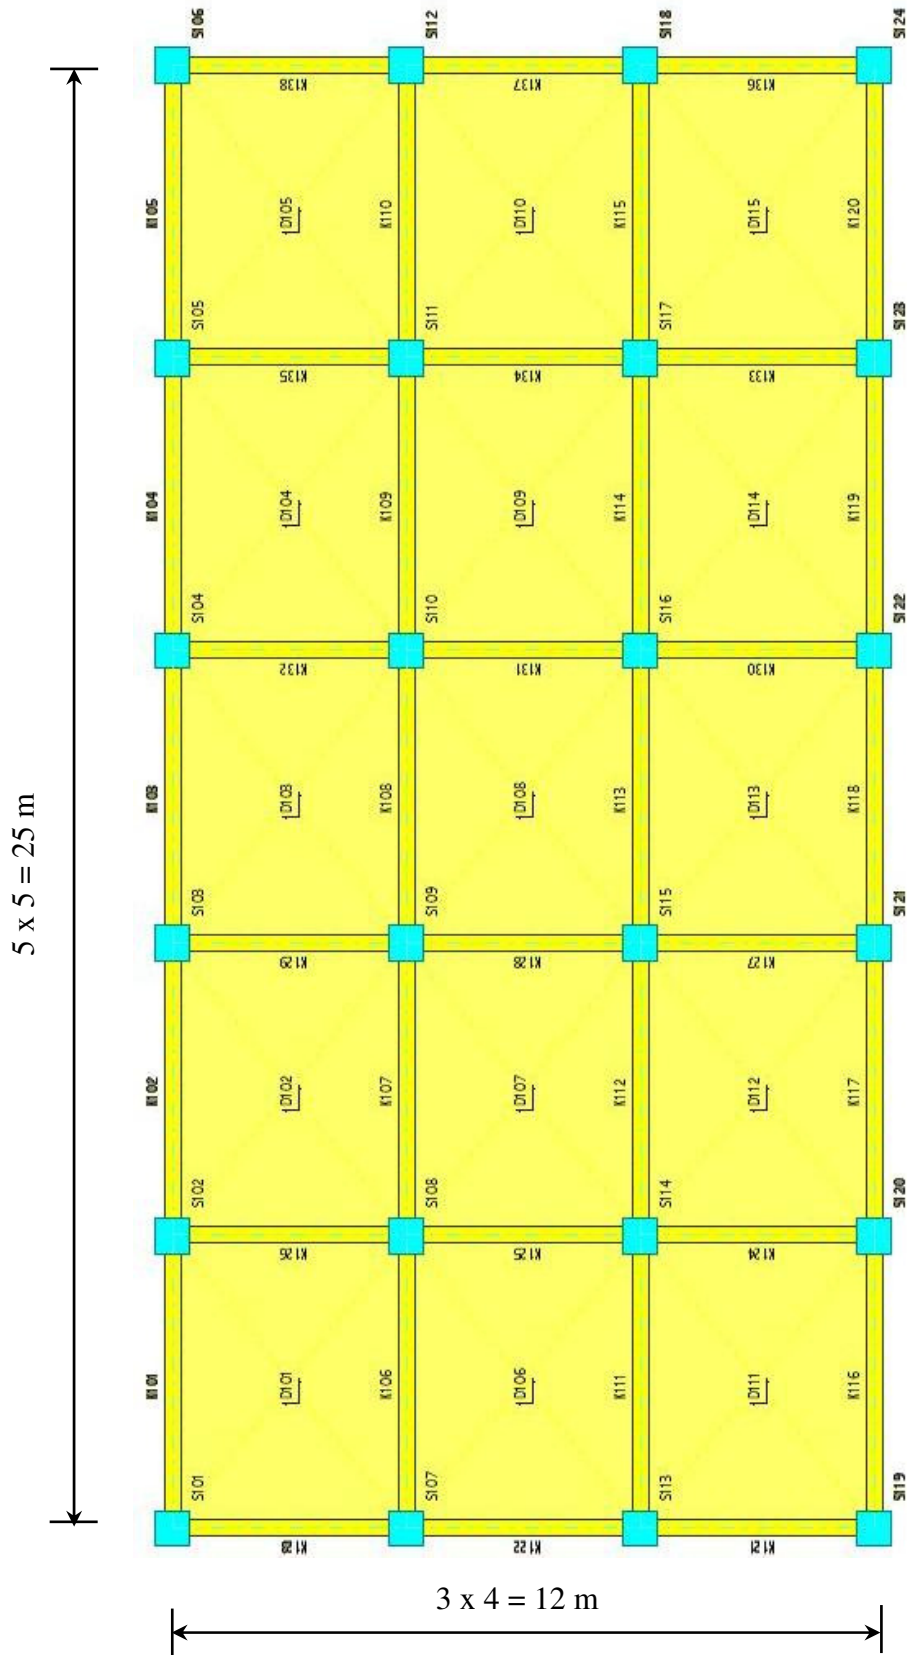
3 açıklıklı binalara ait tipik kat planı
